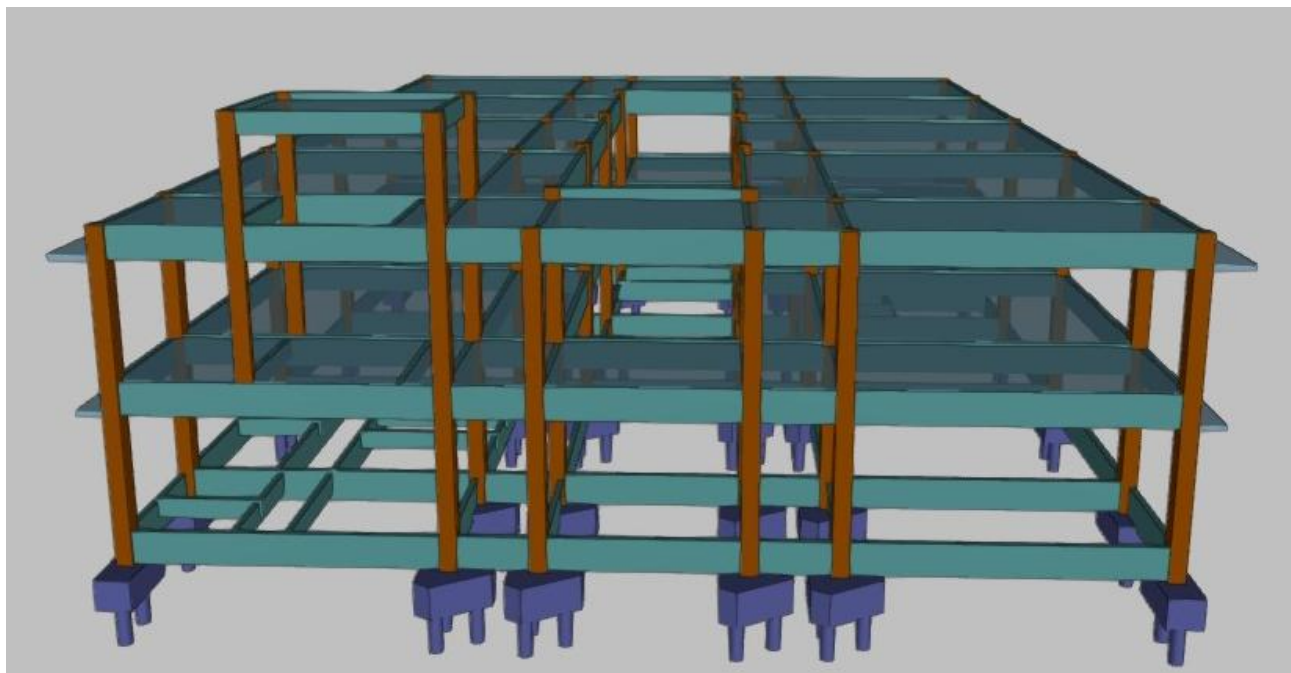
Prédio Escolar Parte 1 – Modelo estrutural 3D vista 2
